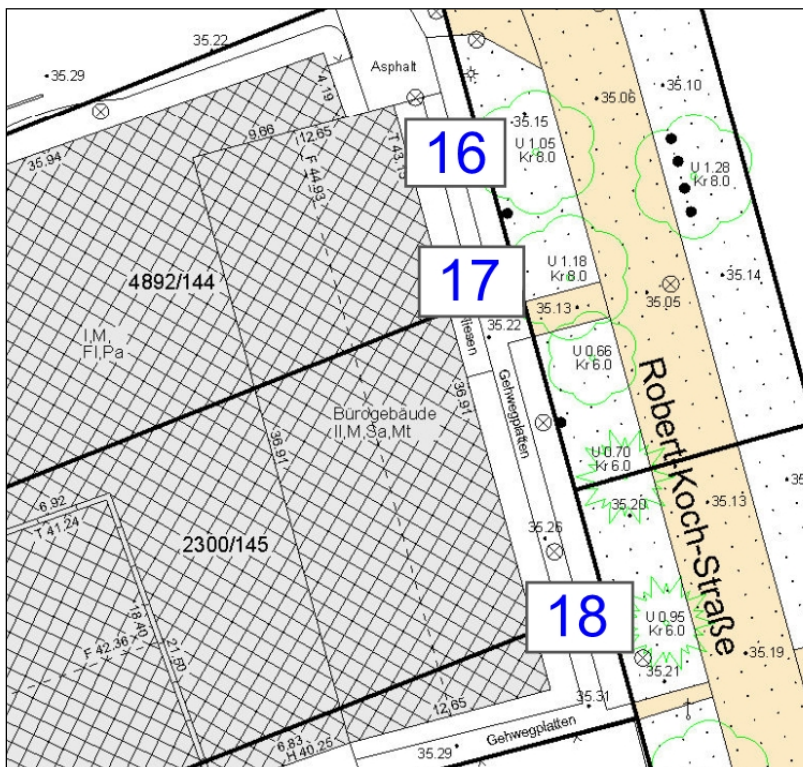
Geschützter Baumbestand im Plangebiet (Robert-Koch-Straße)
